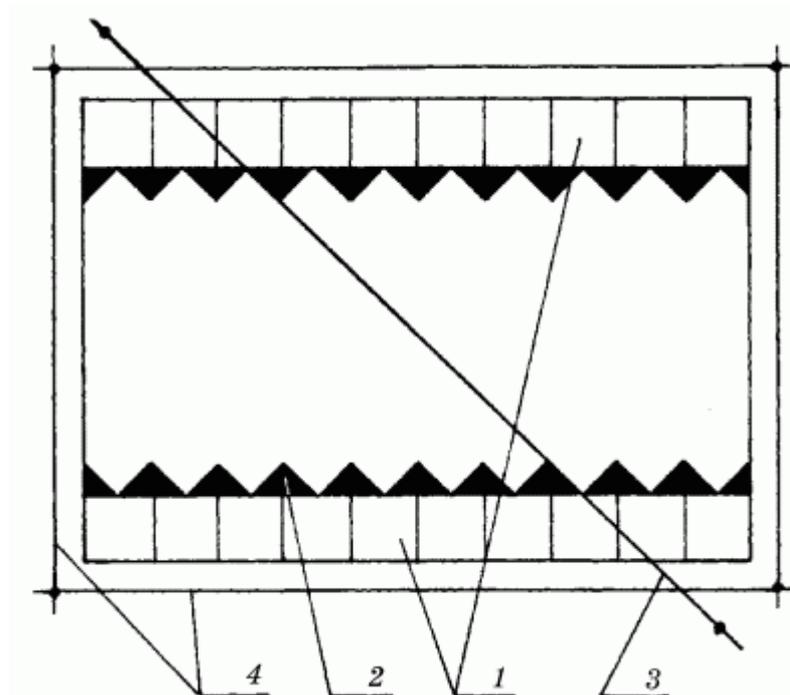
Облицовка стен по диагонали: 1 – прямой верхний ряд; 2 – треугольные плитки; 3 – причальный шнур при укладке плиток наклонными рядами; 4 – причальные шнуры при укладке плиток горизонтальными рядами.
